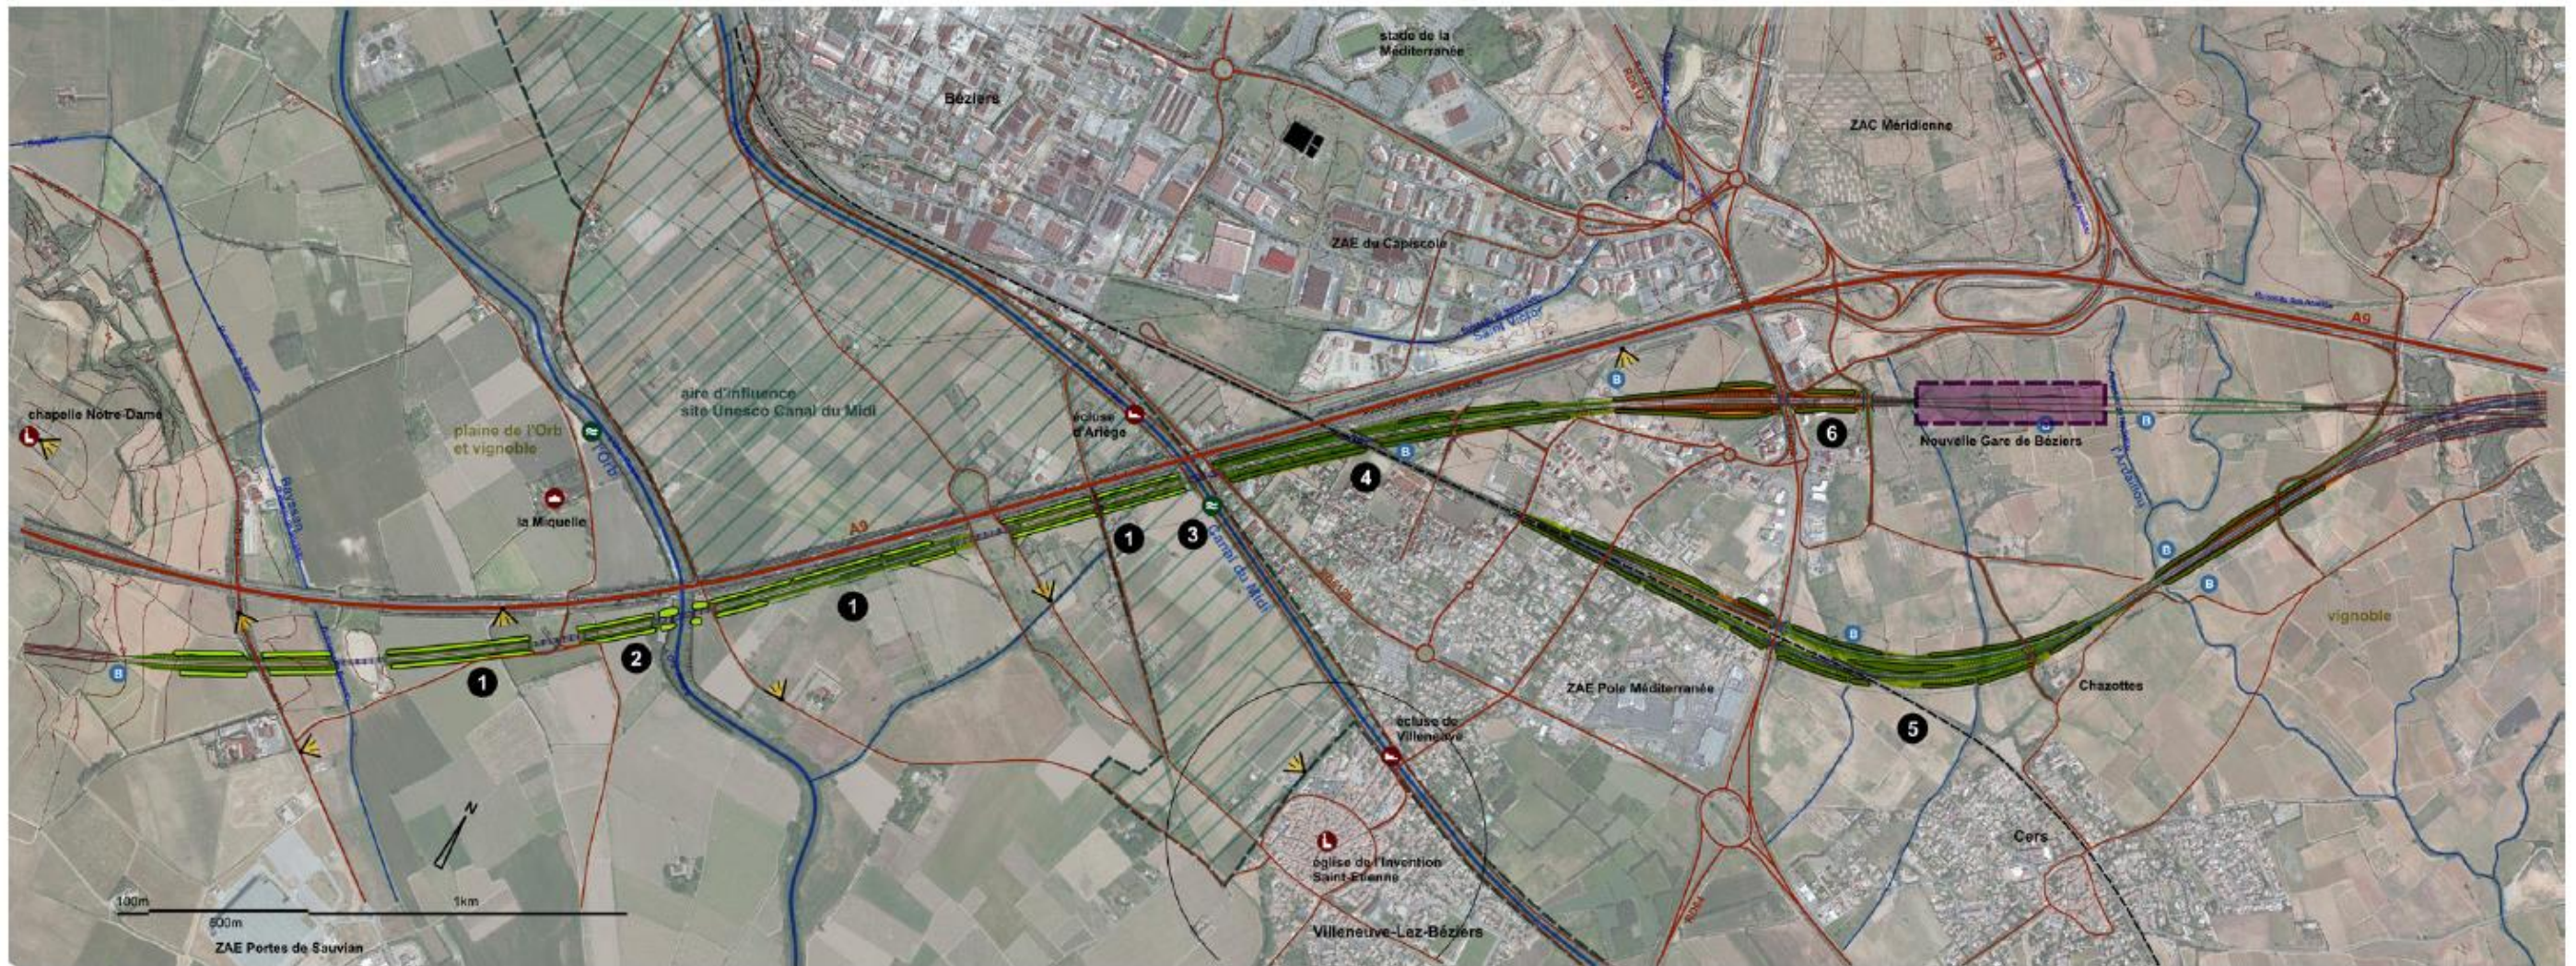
plan des mesures paysagères dans la traversée de Béziers et du canal du Midi (source : Traverses)
